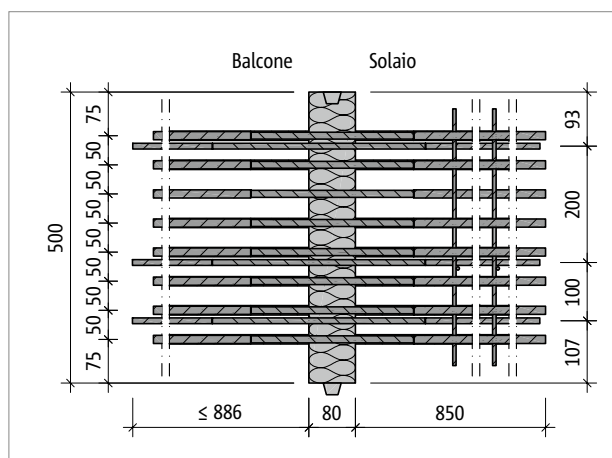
Schöck Isokorb® T tipo K-M14-V3: pianta del prodotto
